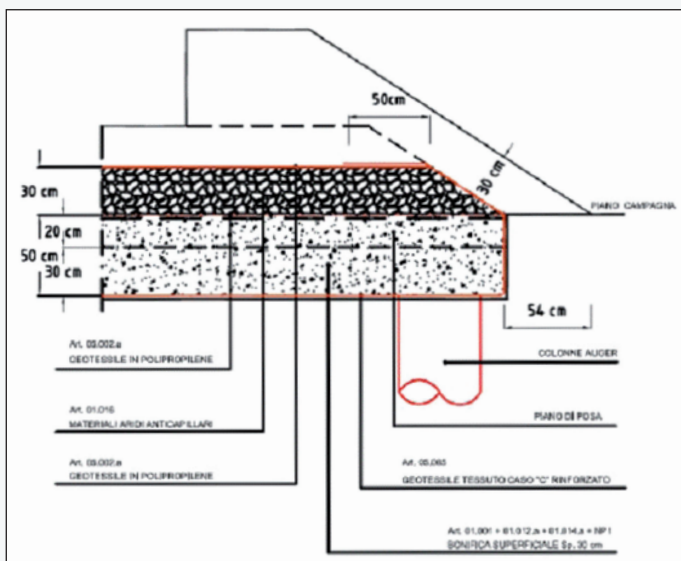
Sezione tipo per rilevati di altezza superiore a 2,0 m con trattamenti colonnari di stabilizzazione profonda tipo "deep mixing"
